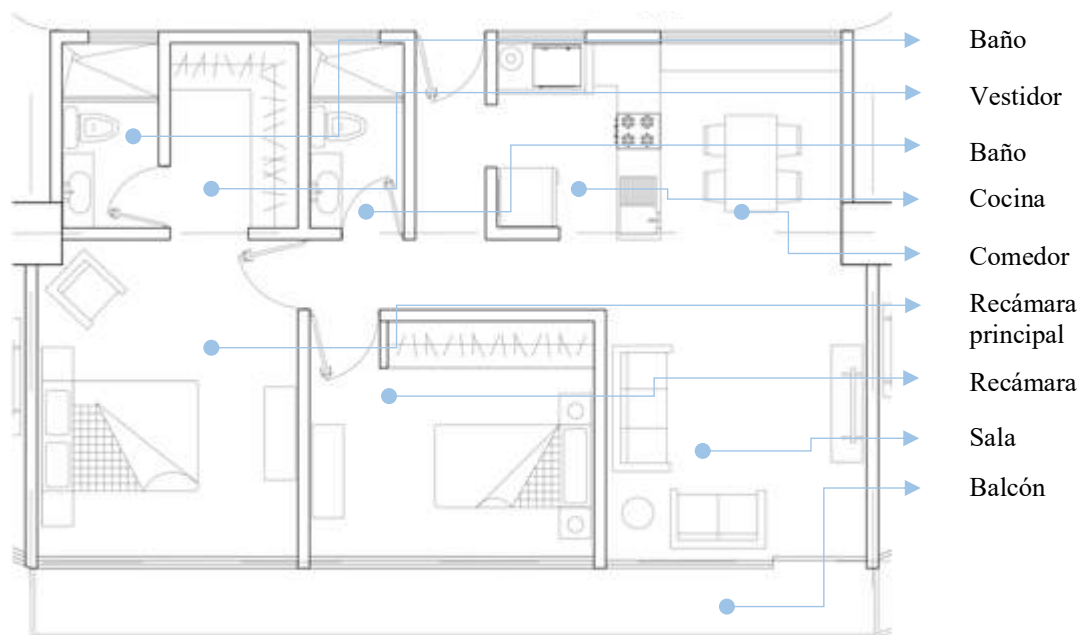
Departamento tipo 1, planta tipo. Fuente: Elaboración propia.
